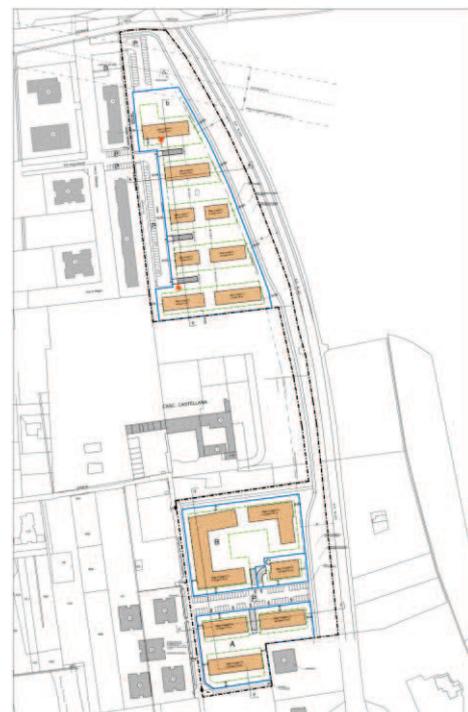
Proposta di Variante al Piano di Lottizzazione P.L.8- Planivolumetrico di progetto – (Fonte: Ufficio Tecnico Comunale)
